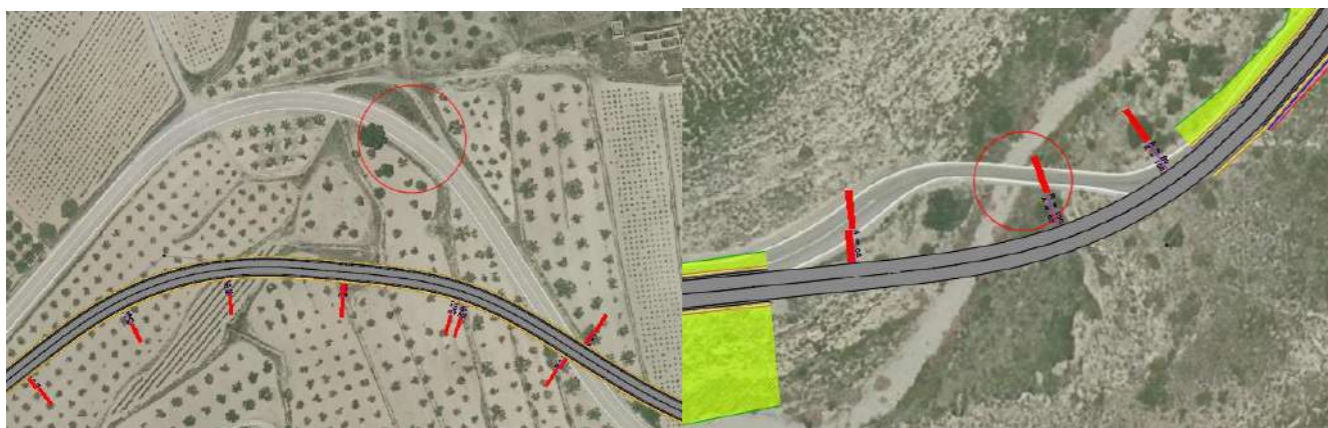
Obras de drenaje transversal situadas en los P.Ks 4+265 y 6+560 Fuente: Elaboración propia
